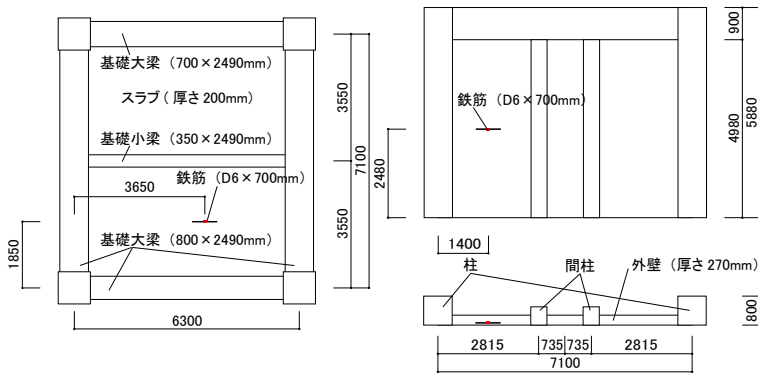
1階床スラブ（伏図）および4階外壁（軸組・断面図）
